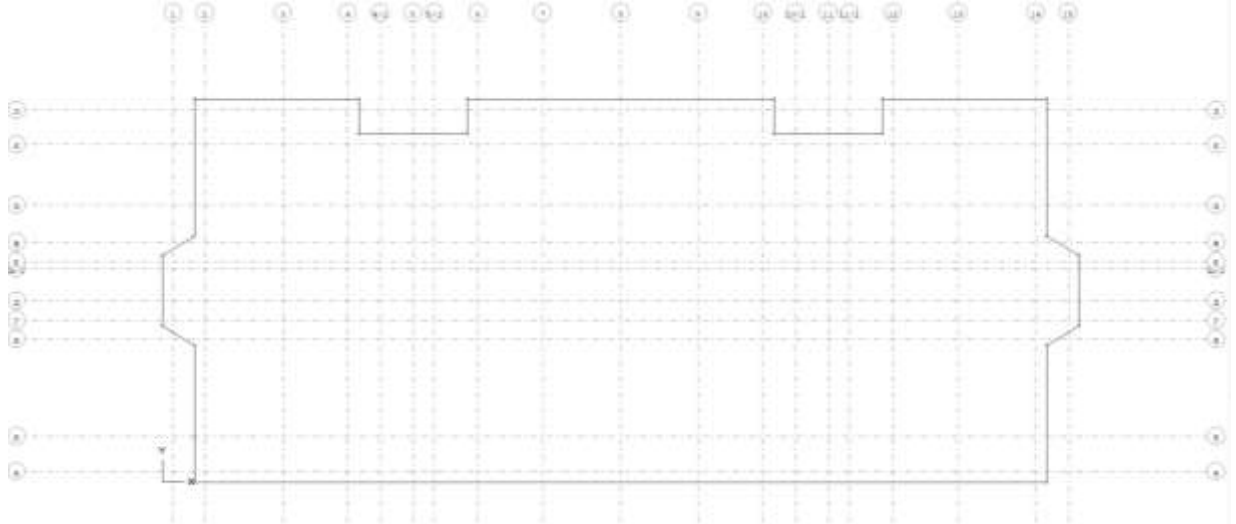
Плита фундаментна ФМ -1. Опалубкове креслення
